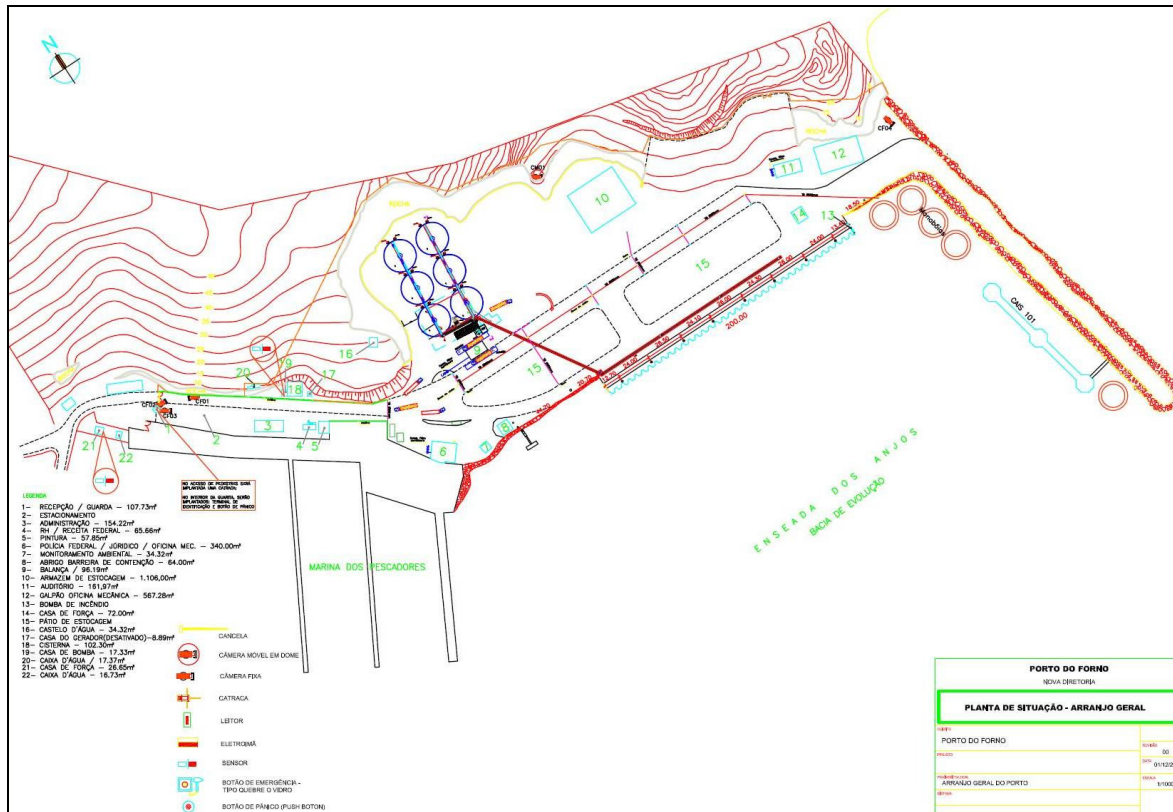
Planta da situação atual do Porto e identificação das estruturas
